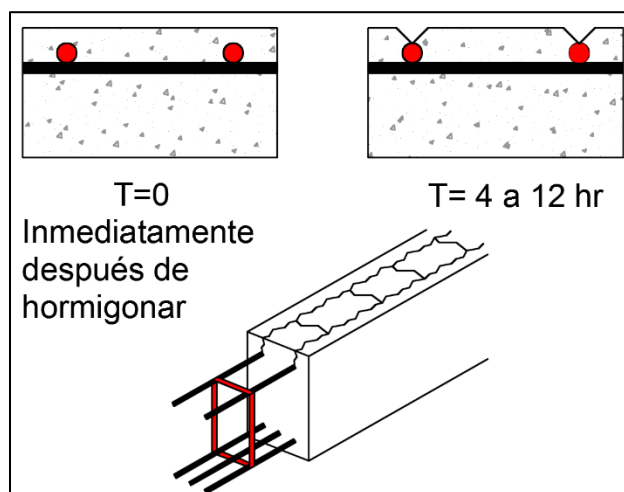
Fisuras de una viga de concreto reforzado por asentamiento plástico.
